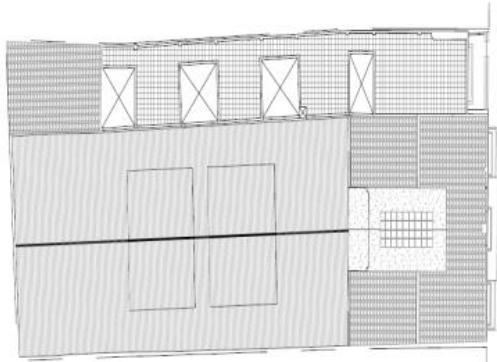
Plano de planta baja (MARTÍNEZ, R., 1939).
